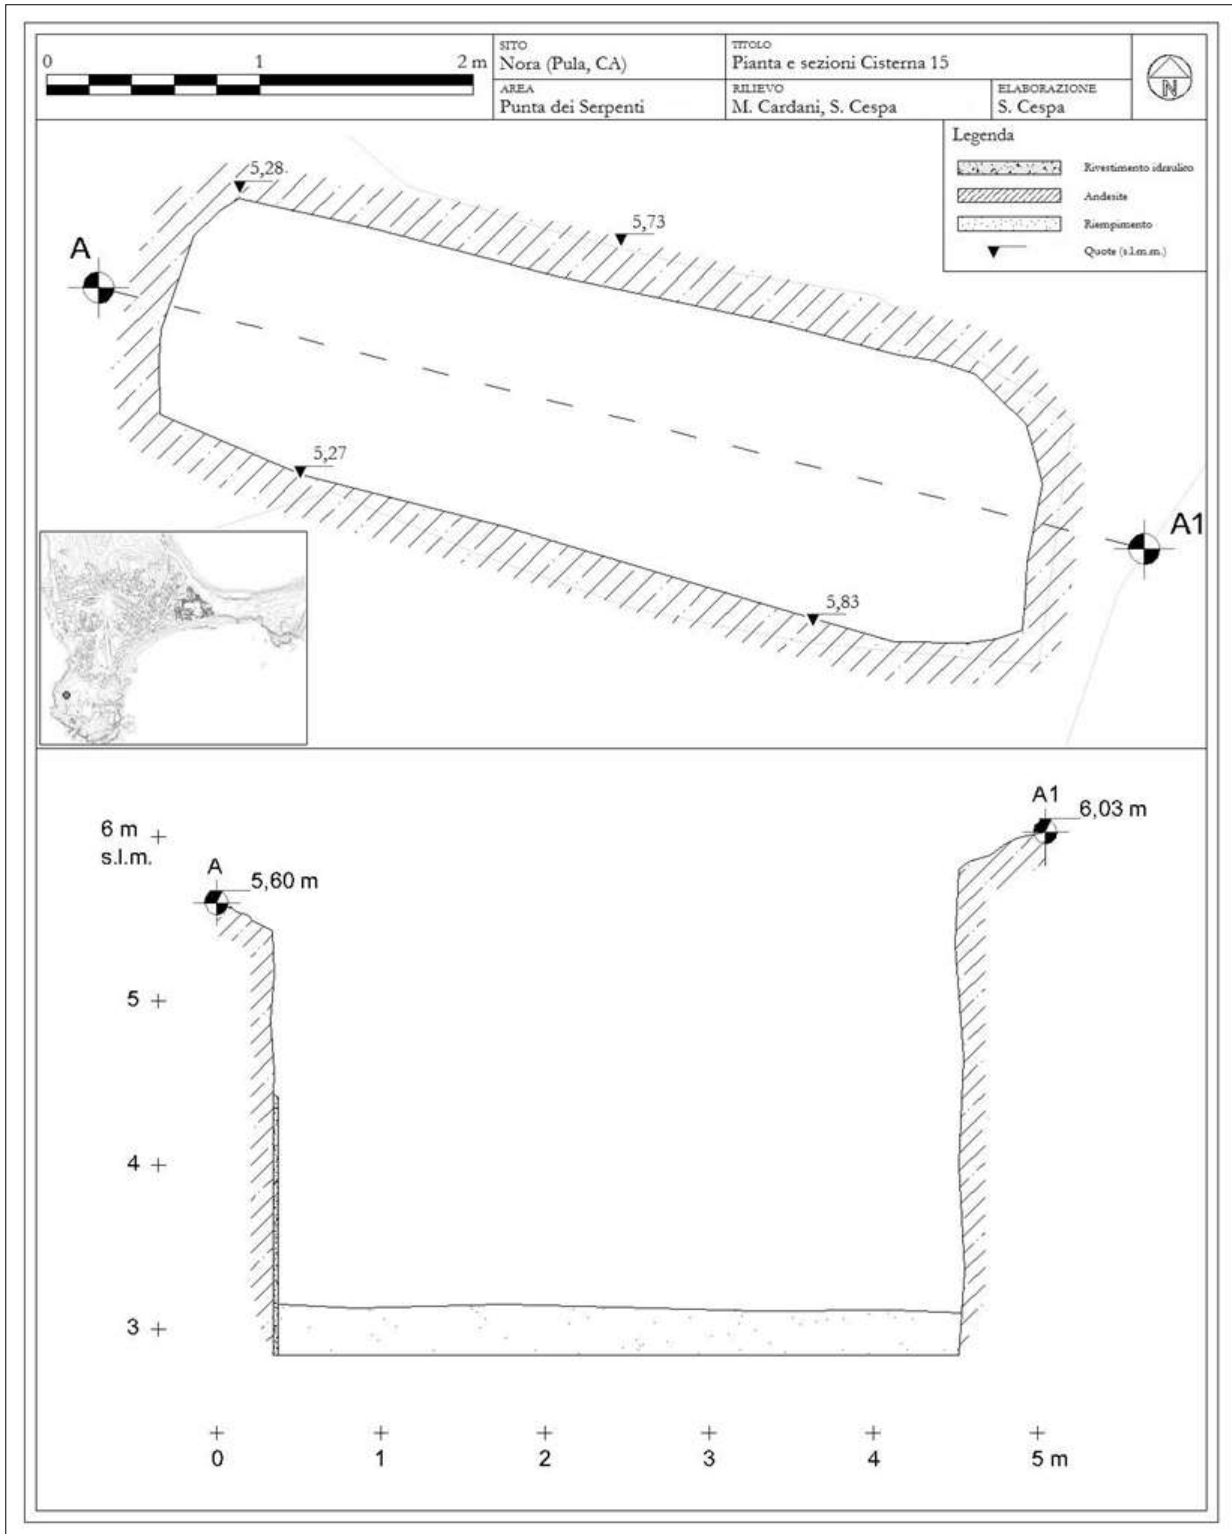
Pianta e sezioni della cisterna 15 (elaborazione dell'autore).
